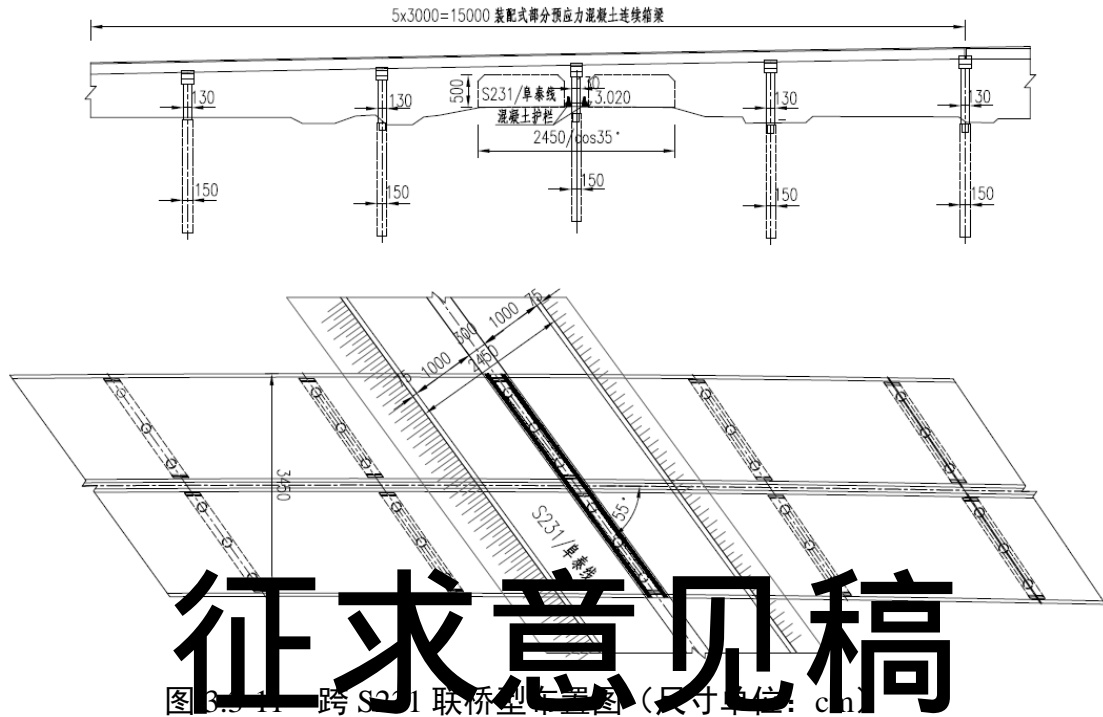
跨 S231 联桥型平面设计图 (尺寸单位: cm)
